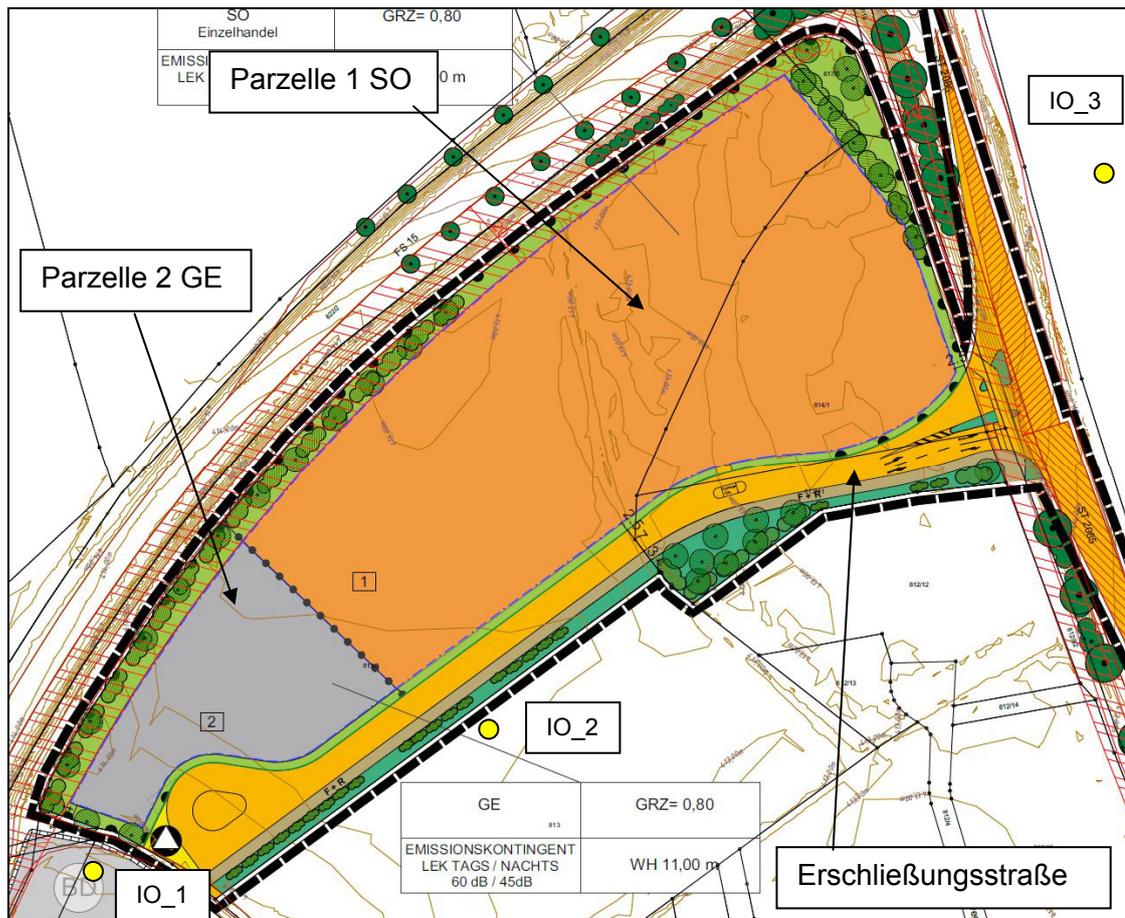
Bebauungsplan "Sondergebiet Amperauen", Lageplan [a]; ● Immissionsort
